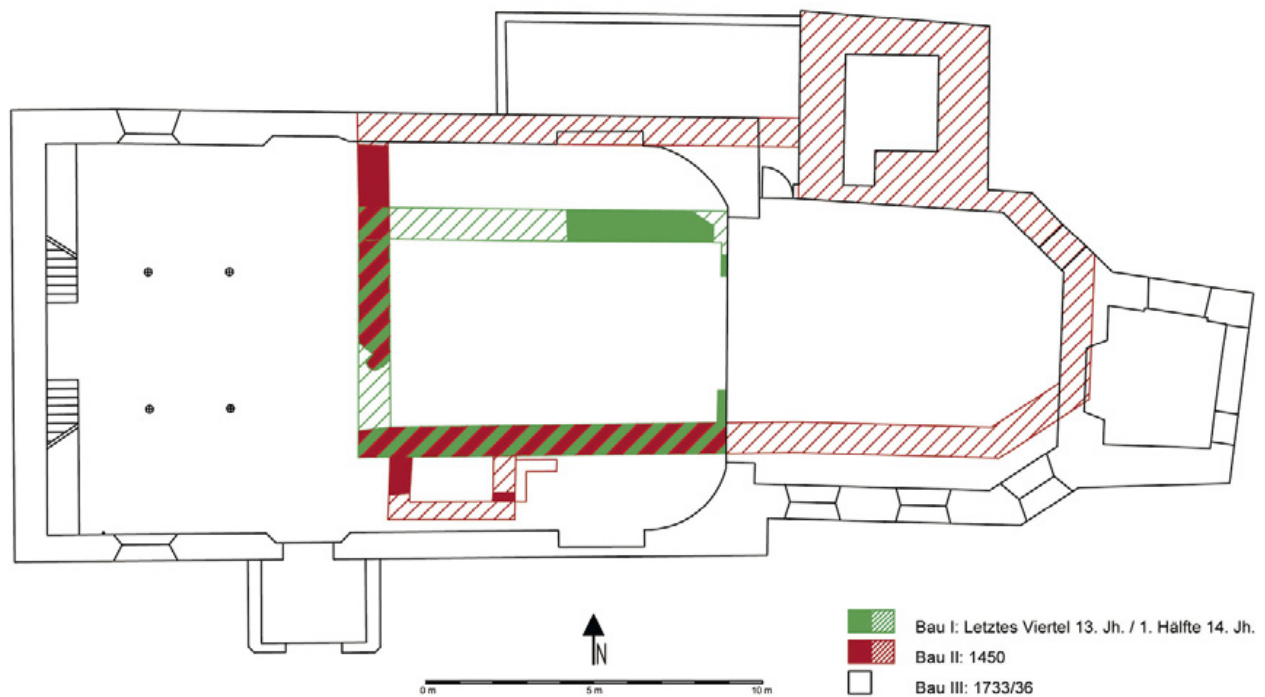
Bichlbach (Mnr. 86004.14.01–02). Pfarrkirche hl. Laurentius. Baualtersplan (Bau I–II).
